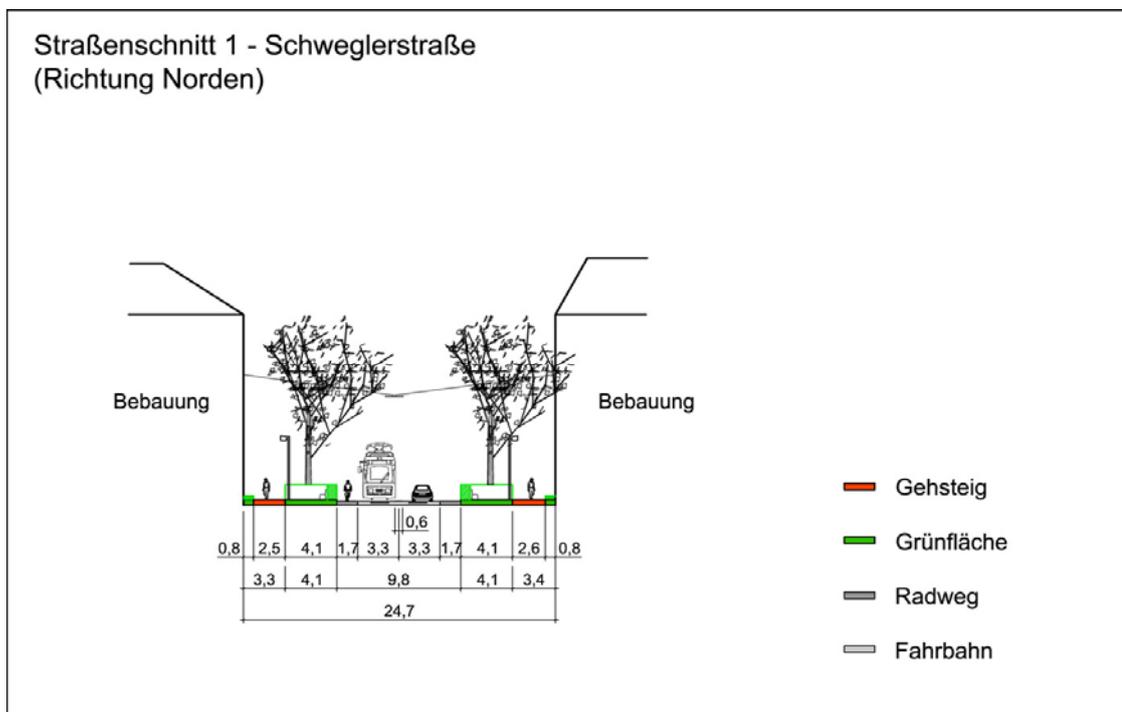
Entwurf - Straßenschnitt Schweglerstraße - Richtung Norden (Quelle: eigener Entwurf, 2008)
